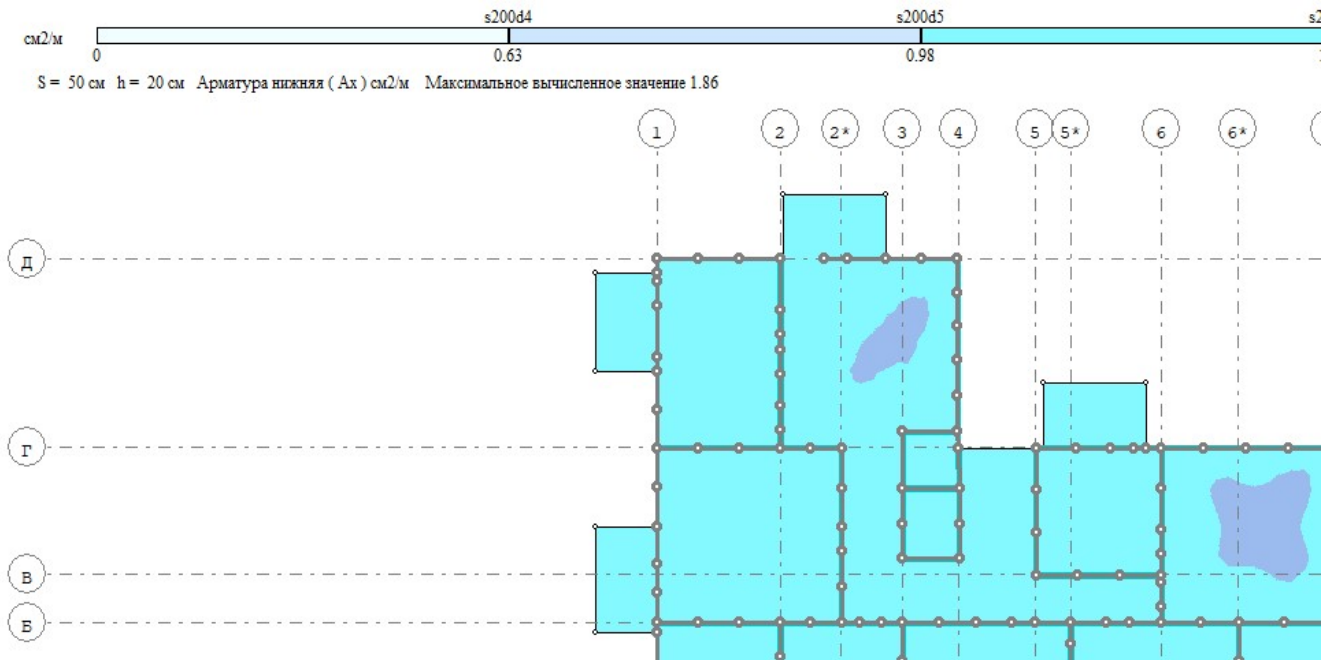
Нижняя зона армирование по оси X(см²/п.м.).
